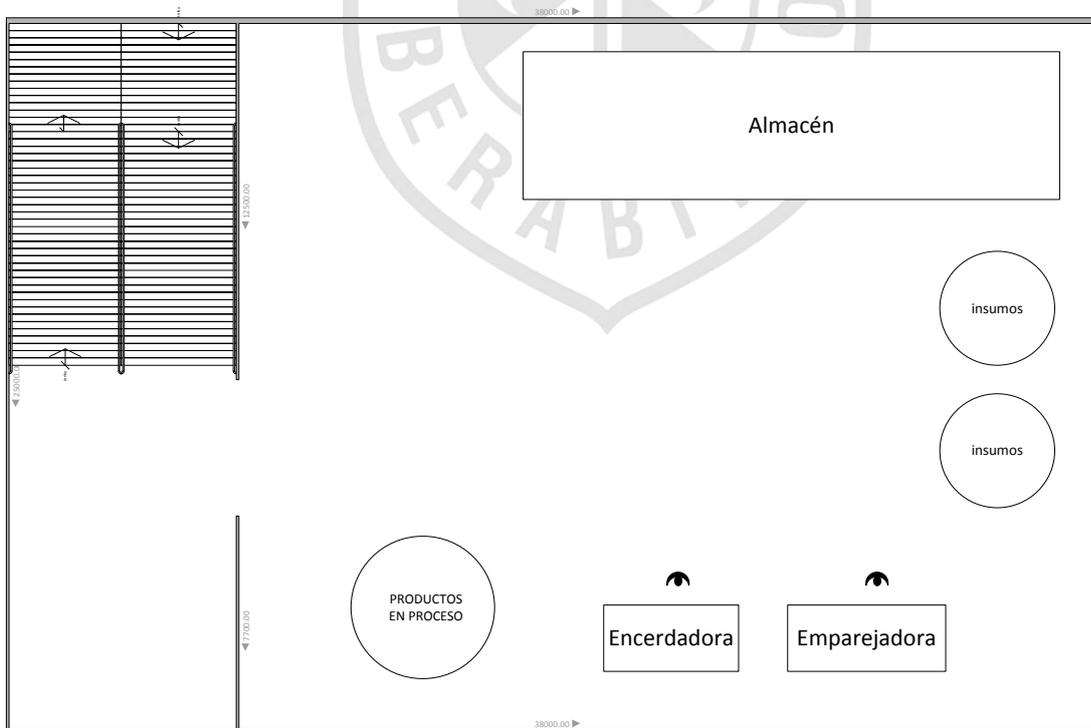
Plano: Vista de Planta del 3er piso LEÓN PLAST
